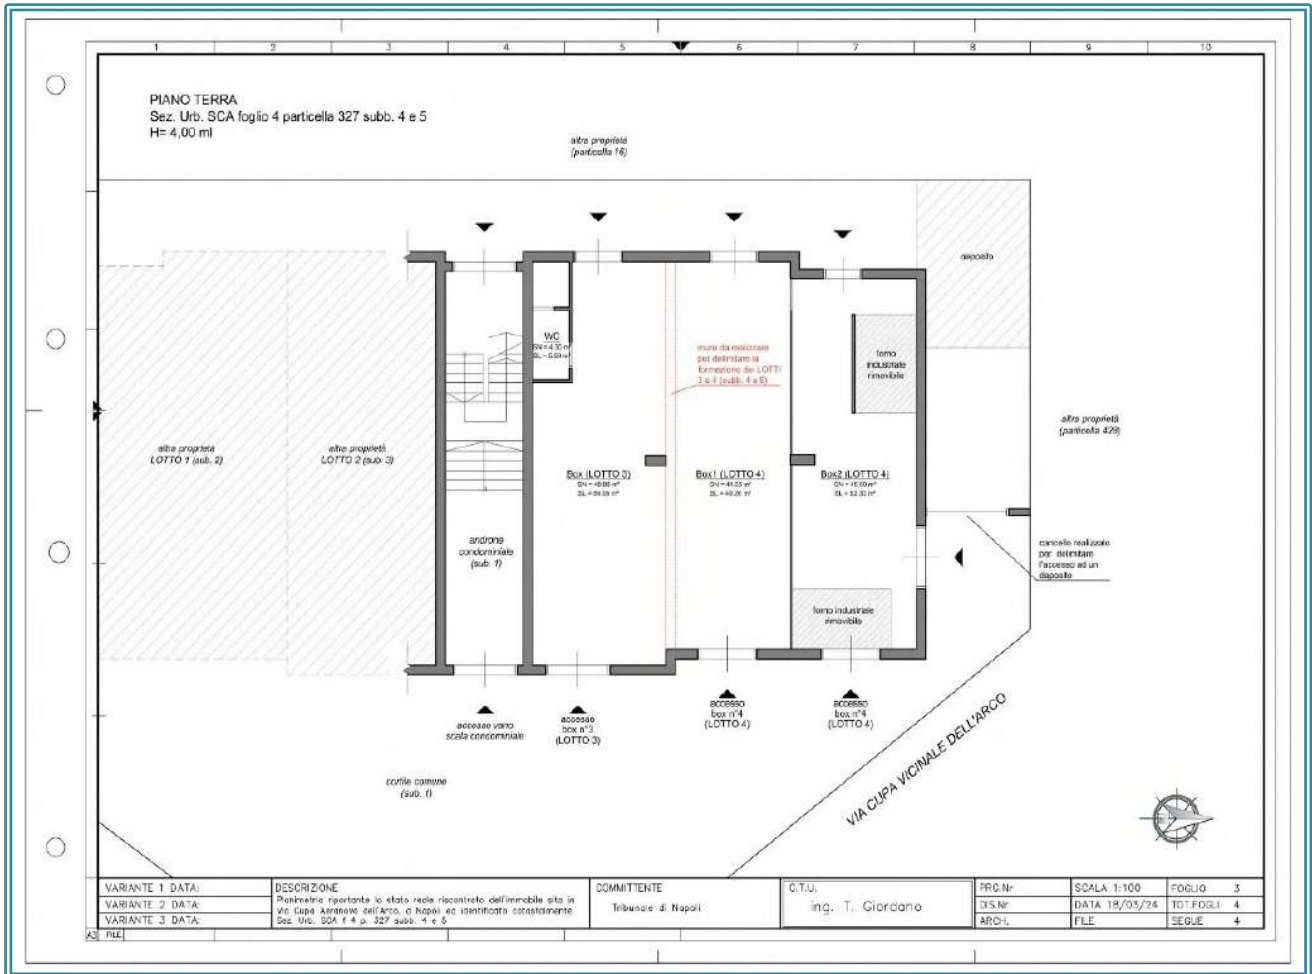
Planimetria stato attuale LOTTI 3 e 4
